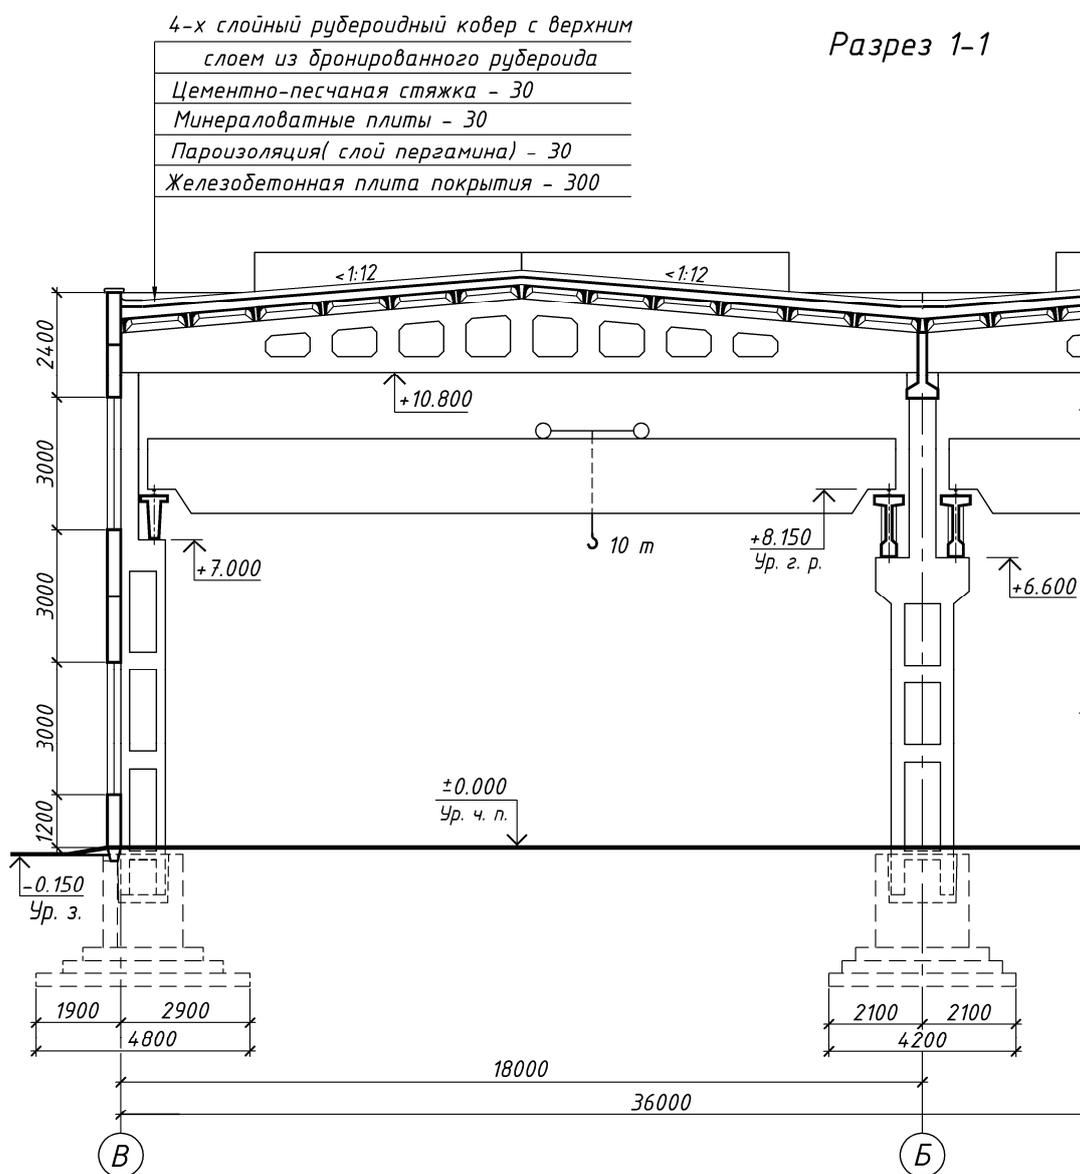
Фрагмент поперечного разреза промышленного здания
